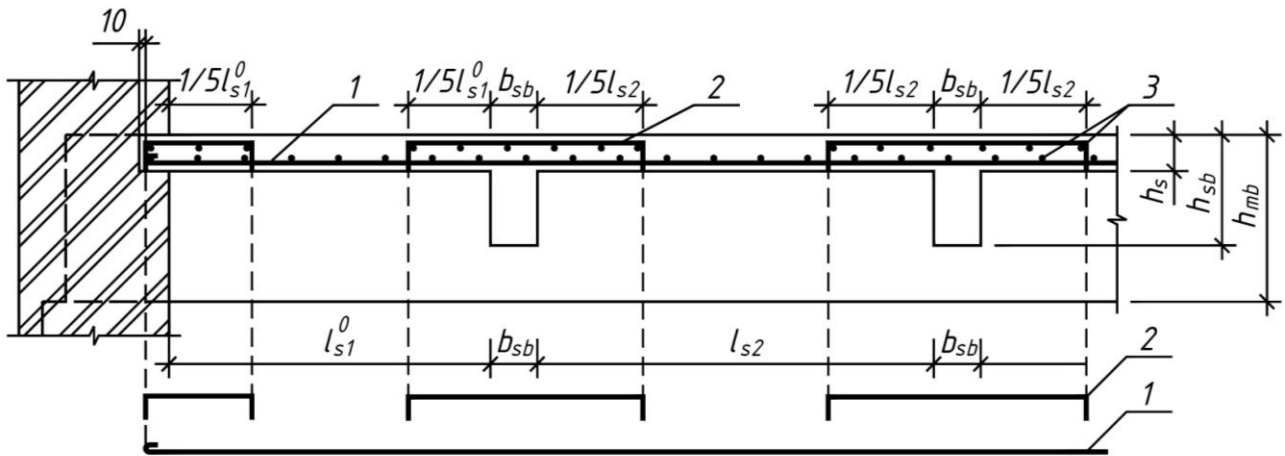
Роздільне армування плити окремими стержнями при $h_s \leq 80$ мм: 1 – робоча арматура в прольоті; 2 – робоча арматура на опорі; 3 – розподільна арматура
